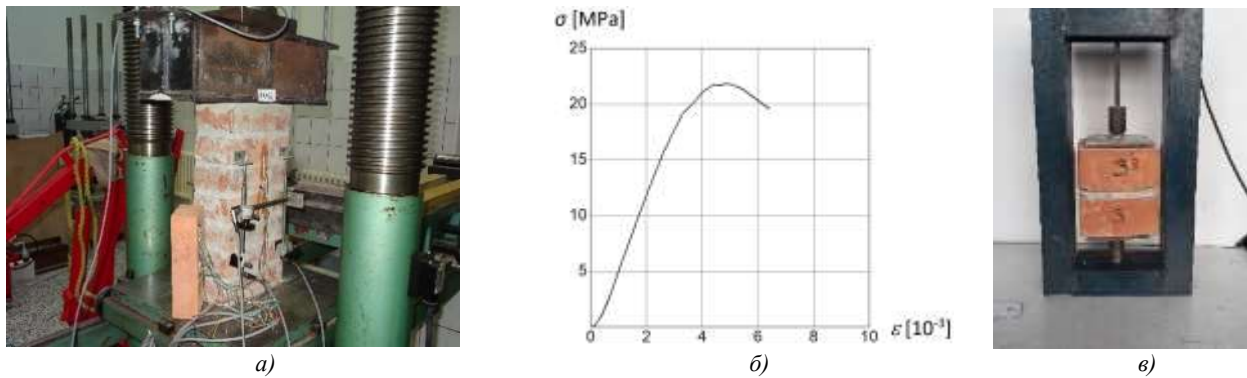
Испытание образцов каменной кладки: а, б — на сжатие; в — на растяжение поперек растворных швов [10]
